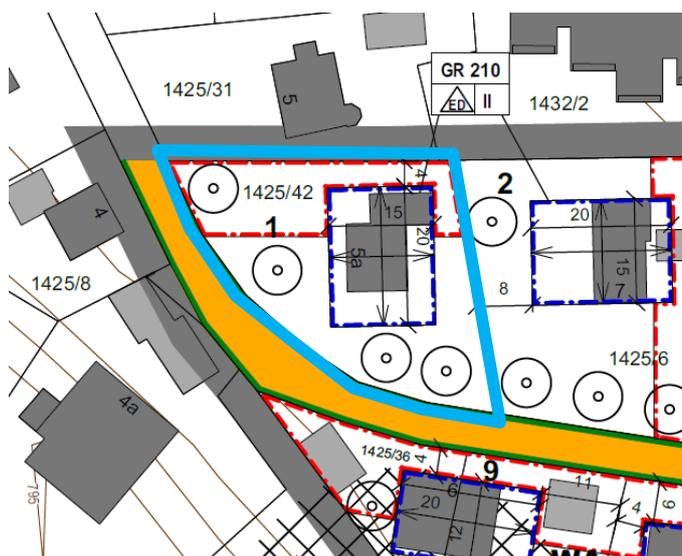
Ausschnitt Ursprungsbebauungsplan Nr. 79 2 Breitensteinstr.“ mit Lage 1.Änderung (blau)
